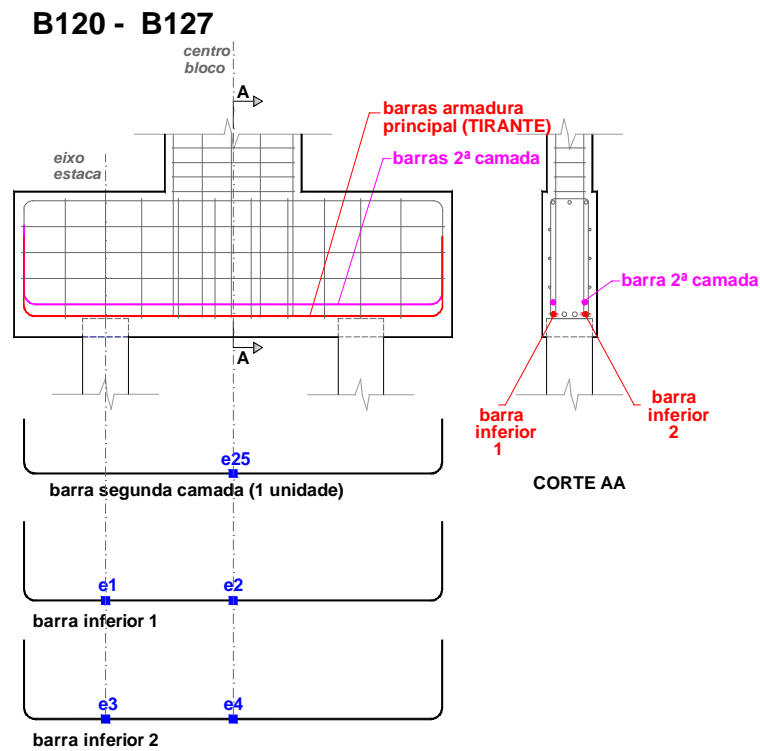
Posicionamento dos extensômetros nas barras da armadura do tirante
